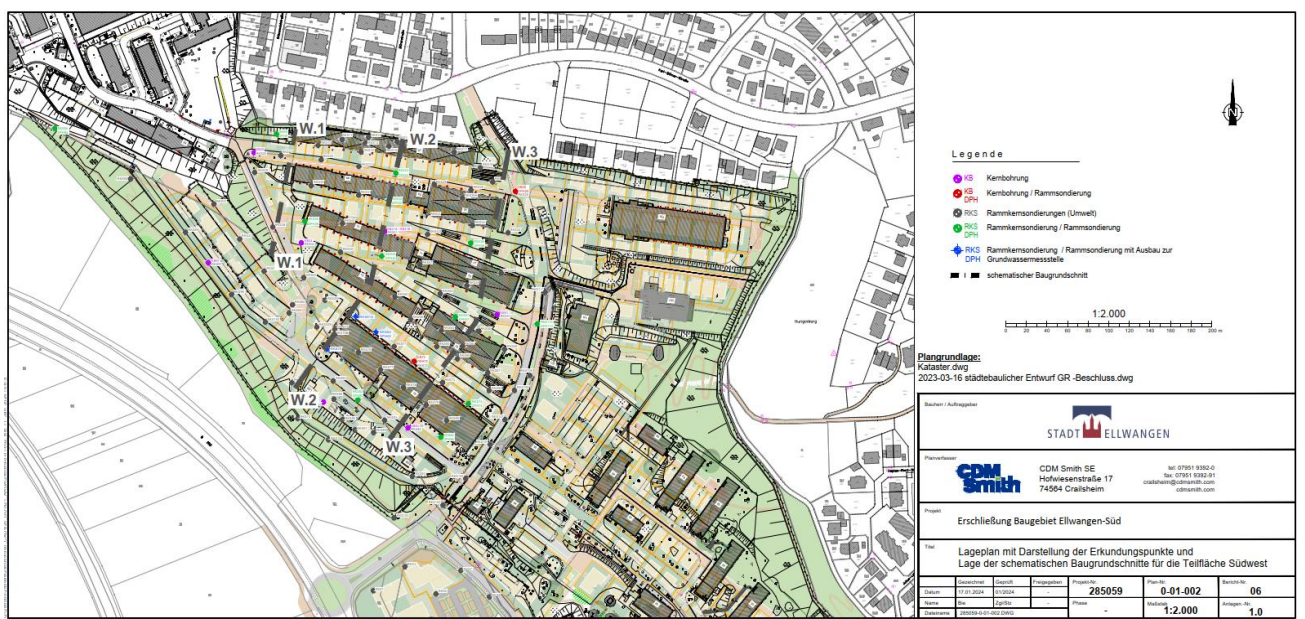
Lageplan mit Erkundungspunkten und Schnittebenen Teilfläche West
